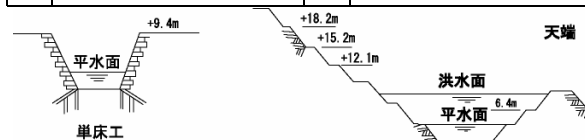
明治期の横断面図(左:狭窄部横断面図, 右:一般部横断面図)
